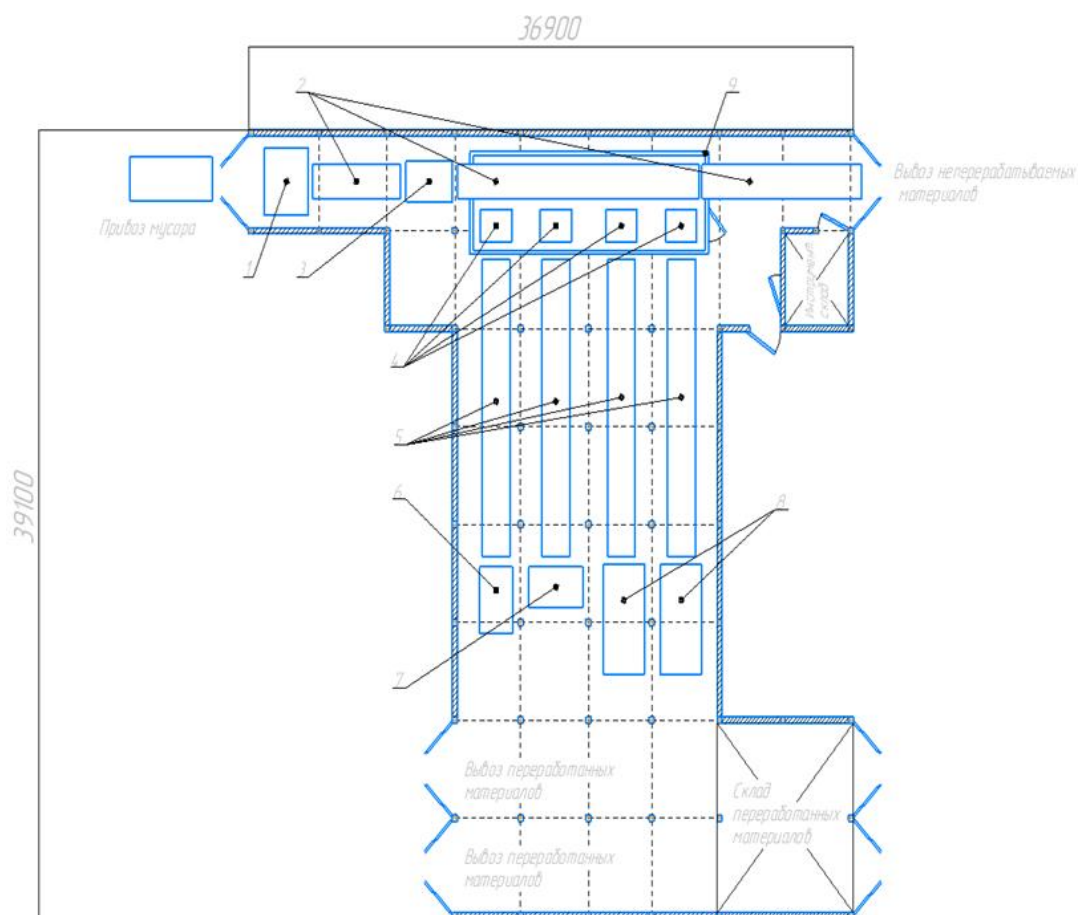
План-схема мусоросортировочного комплекса: 1 – загрузочный бункер; 2 – ленточные конвейеры; 3 – барабанный грохот; 4 – сортировочные бункеры; 5 – промежуточные конвейеры; 6 – измельчитель стекла; 7 – дробилка; 8 – пресс; 9 – сортировочный участок
